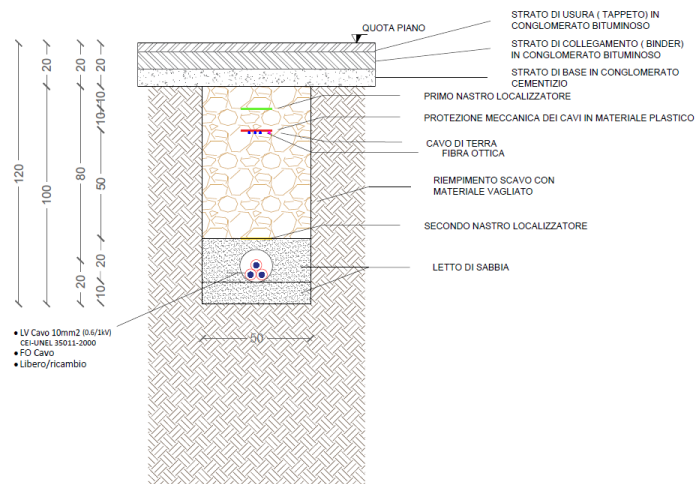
Particolare attraversamento del cavidotto in MT su strada esistente asfaltata
